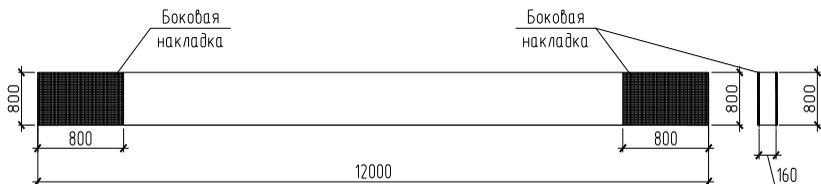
Расчетная схема балки с боковыми накладками из сеток
